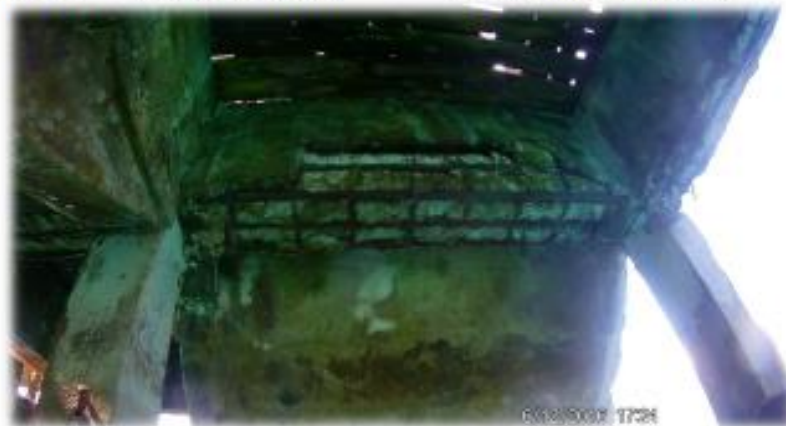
Terdapat kesan keretakan yang teruk pada beam
